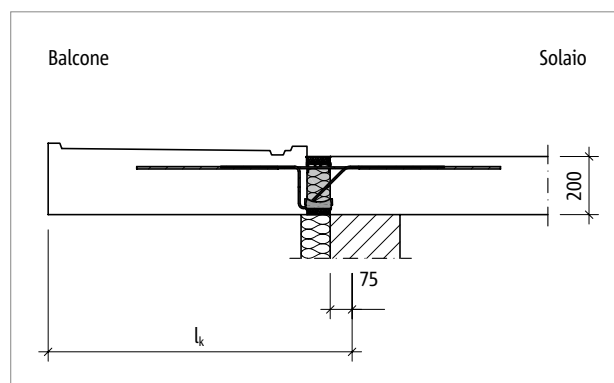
Schöck Isokorb® T tipo K: schema statico
